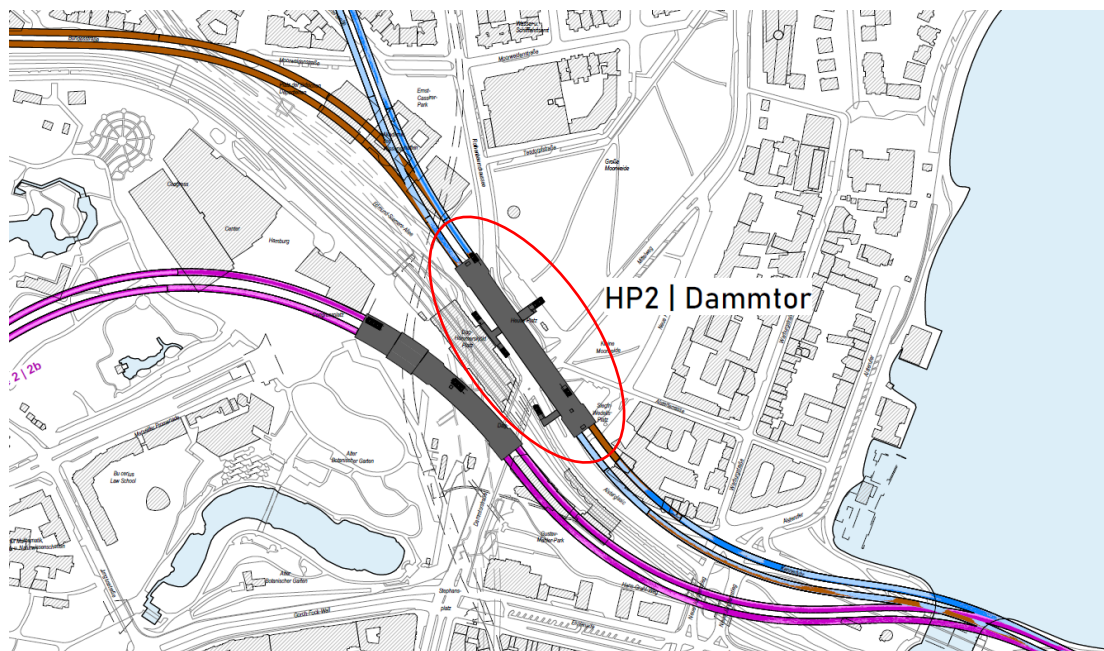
Lageplan Stationsbauwerk HP 2 Dammtor, Variante 1 (blau/hellblau) bzw. 3 (braun), Station I (NE) (Variantenstudie).
